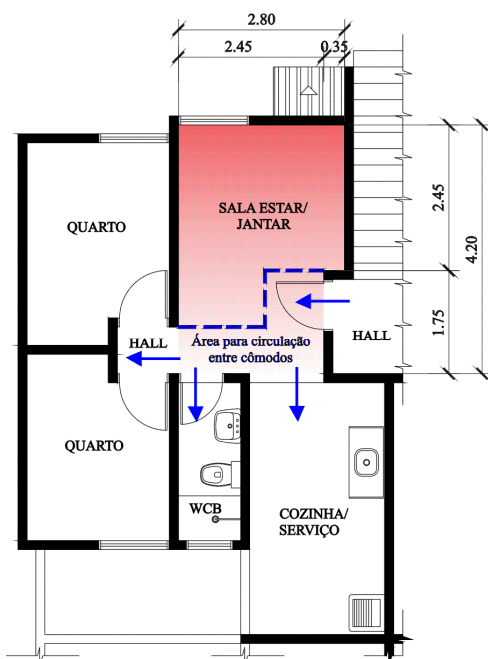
Planta Baixa Pav. Tipo: Setor Social do Residencial Ouro Preto I (sem escala)
